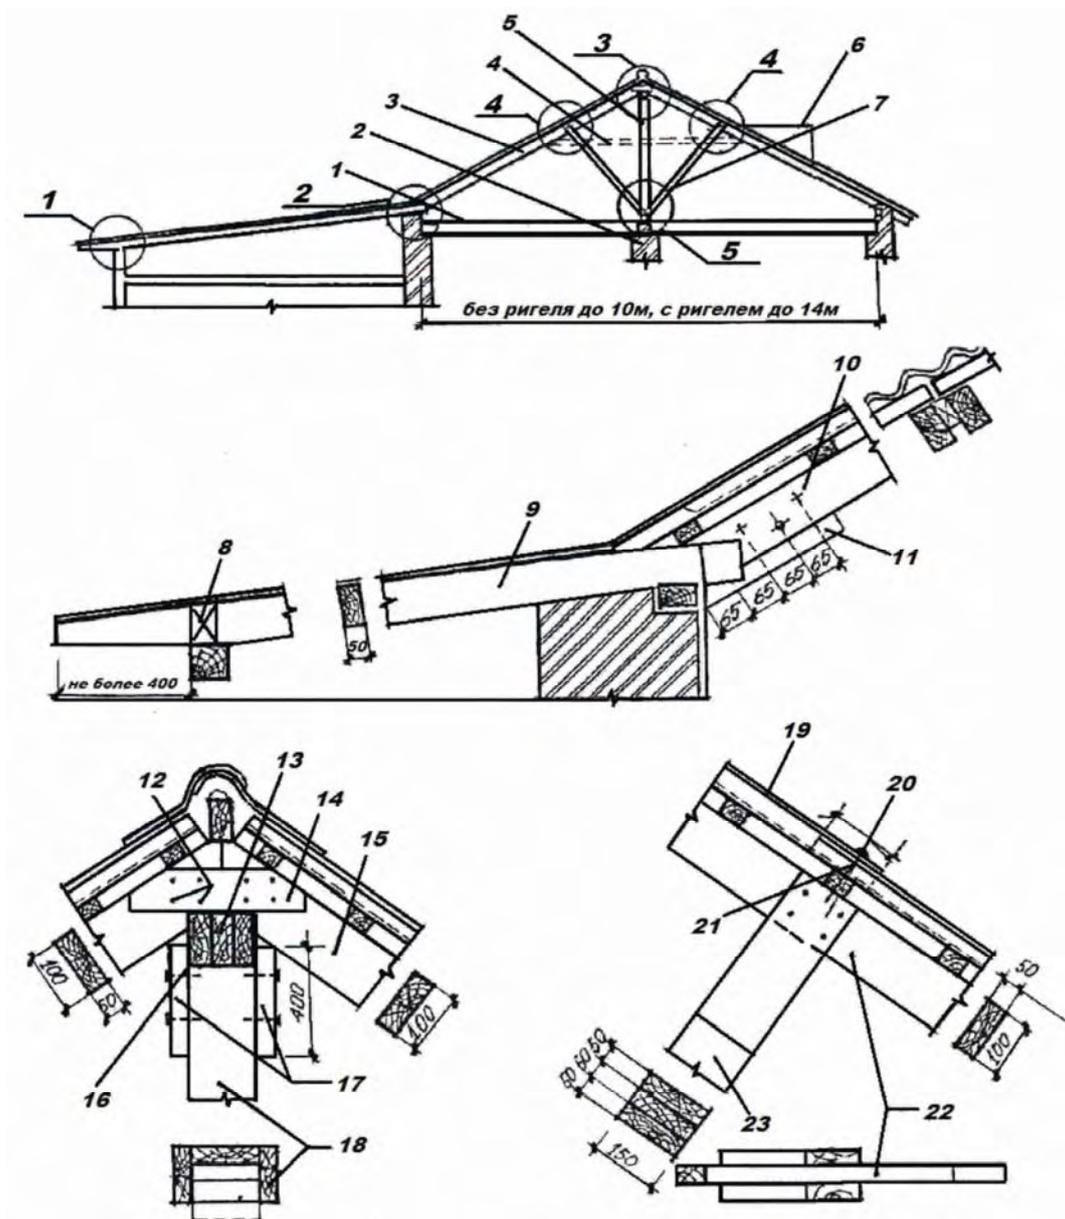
I вариант узлов сопряжения в стропильной системе: 1 — перекрытие; 2 — продольная стена; 3, 10 — стропильная нога; 4 — ригель; 5 — стойка; 6 — слуховое окно; 7 — подкос; 8 — закладка; 9 — участок стропильной ноги, соприкасающийся с кирпичной кладкой, обернутый двумя слоями толя; 11 — опорный брус 50×50 ; 12 — гвозди; 13 — прокладки; 14 — накладки толи $20 \dots 30$; 15 — стропильная нога 100×50 ; 16 — стойка 100×150 ; 17 — накладки 50 , $r = 400$; 18 — стойка из двух или трех досок; 19 — волокнистые асбестоцементные листы; 20 — накладки $20 \dots 30$; 21 — гвоздь с антикоррозийной шляпкой $d4$, $L100$; 22 — стропильная нога $50 \times 100 \times 150$; 23 — подкос 50×100
